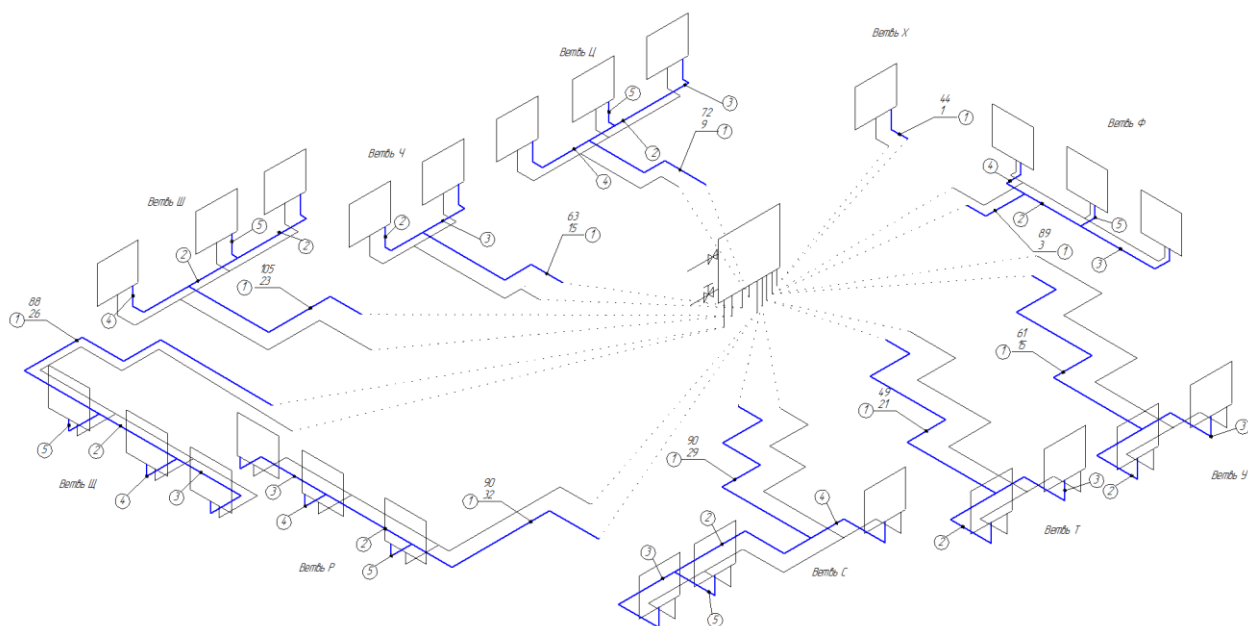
Расчетная схема отопления 3-го этажа
